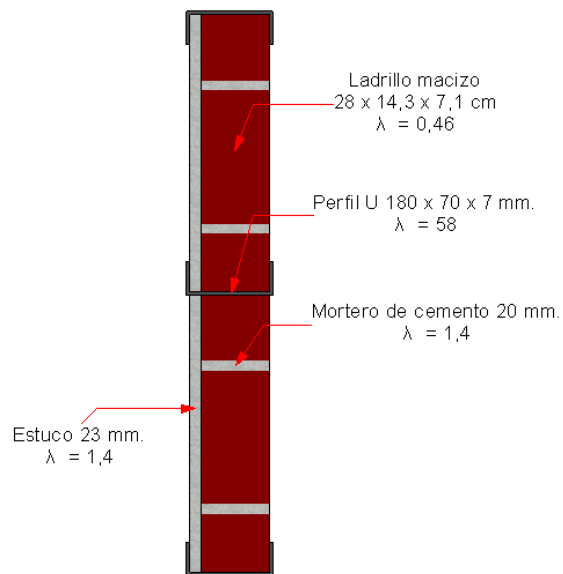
Configuración de la albañilería con los refuerzos metálicos.
